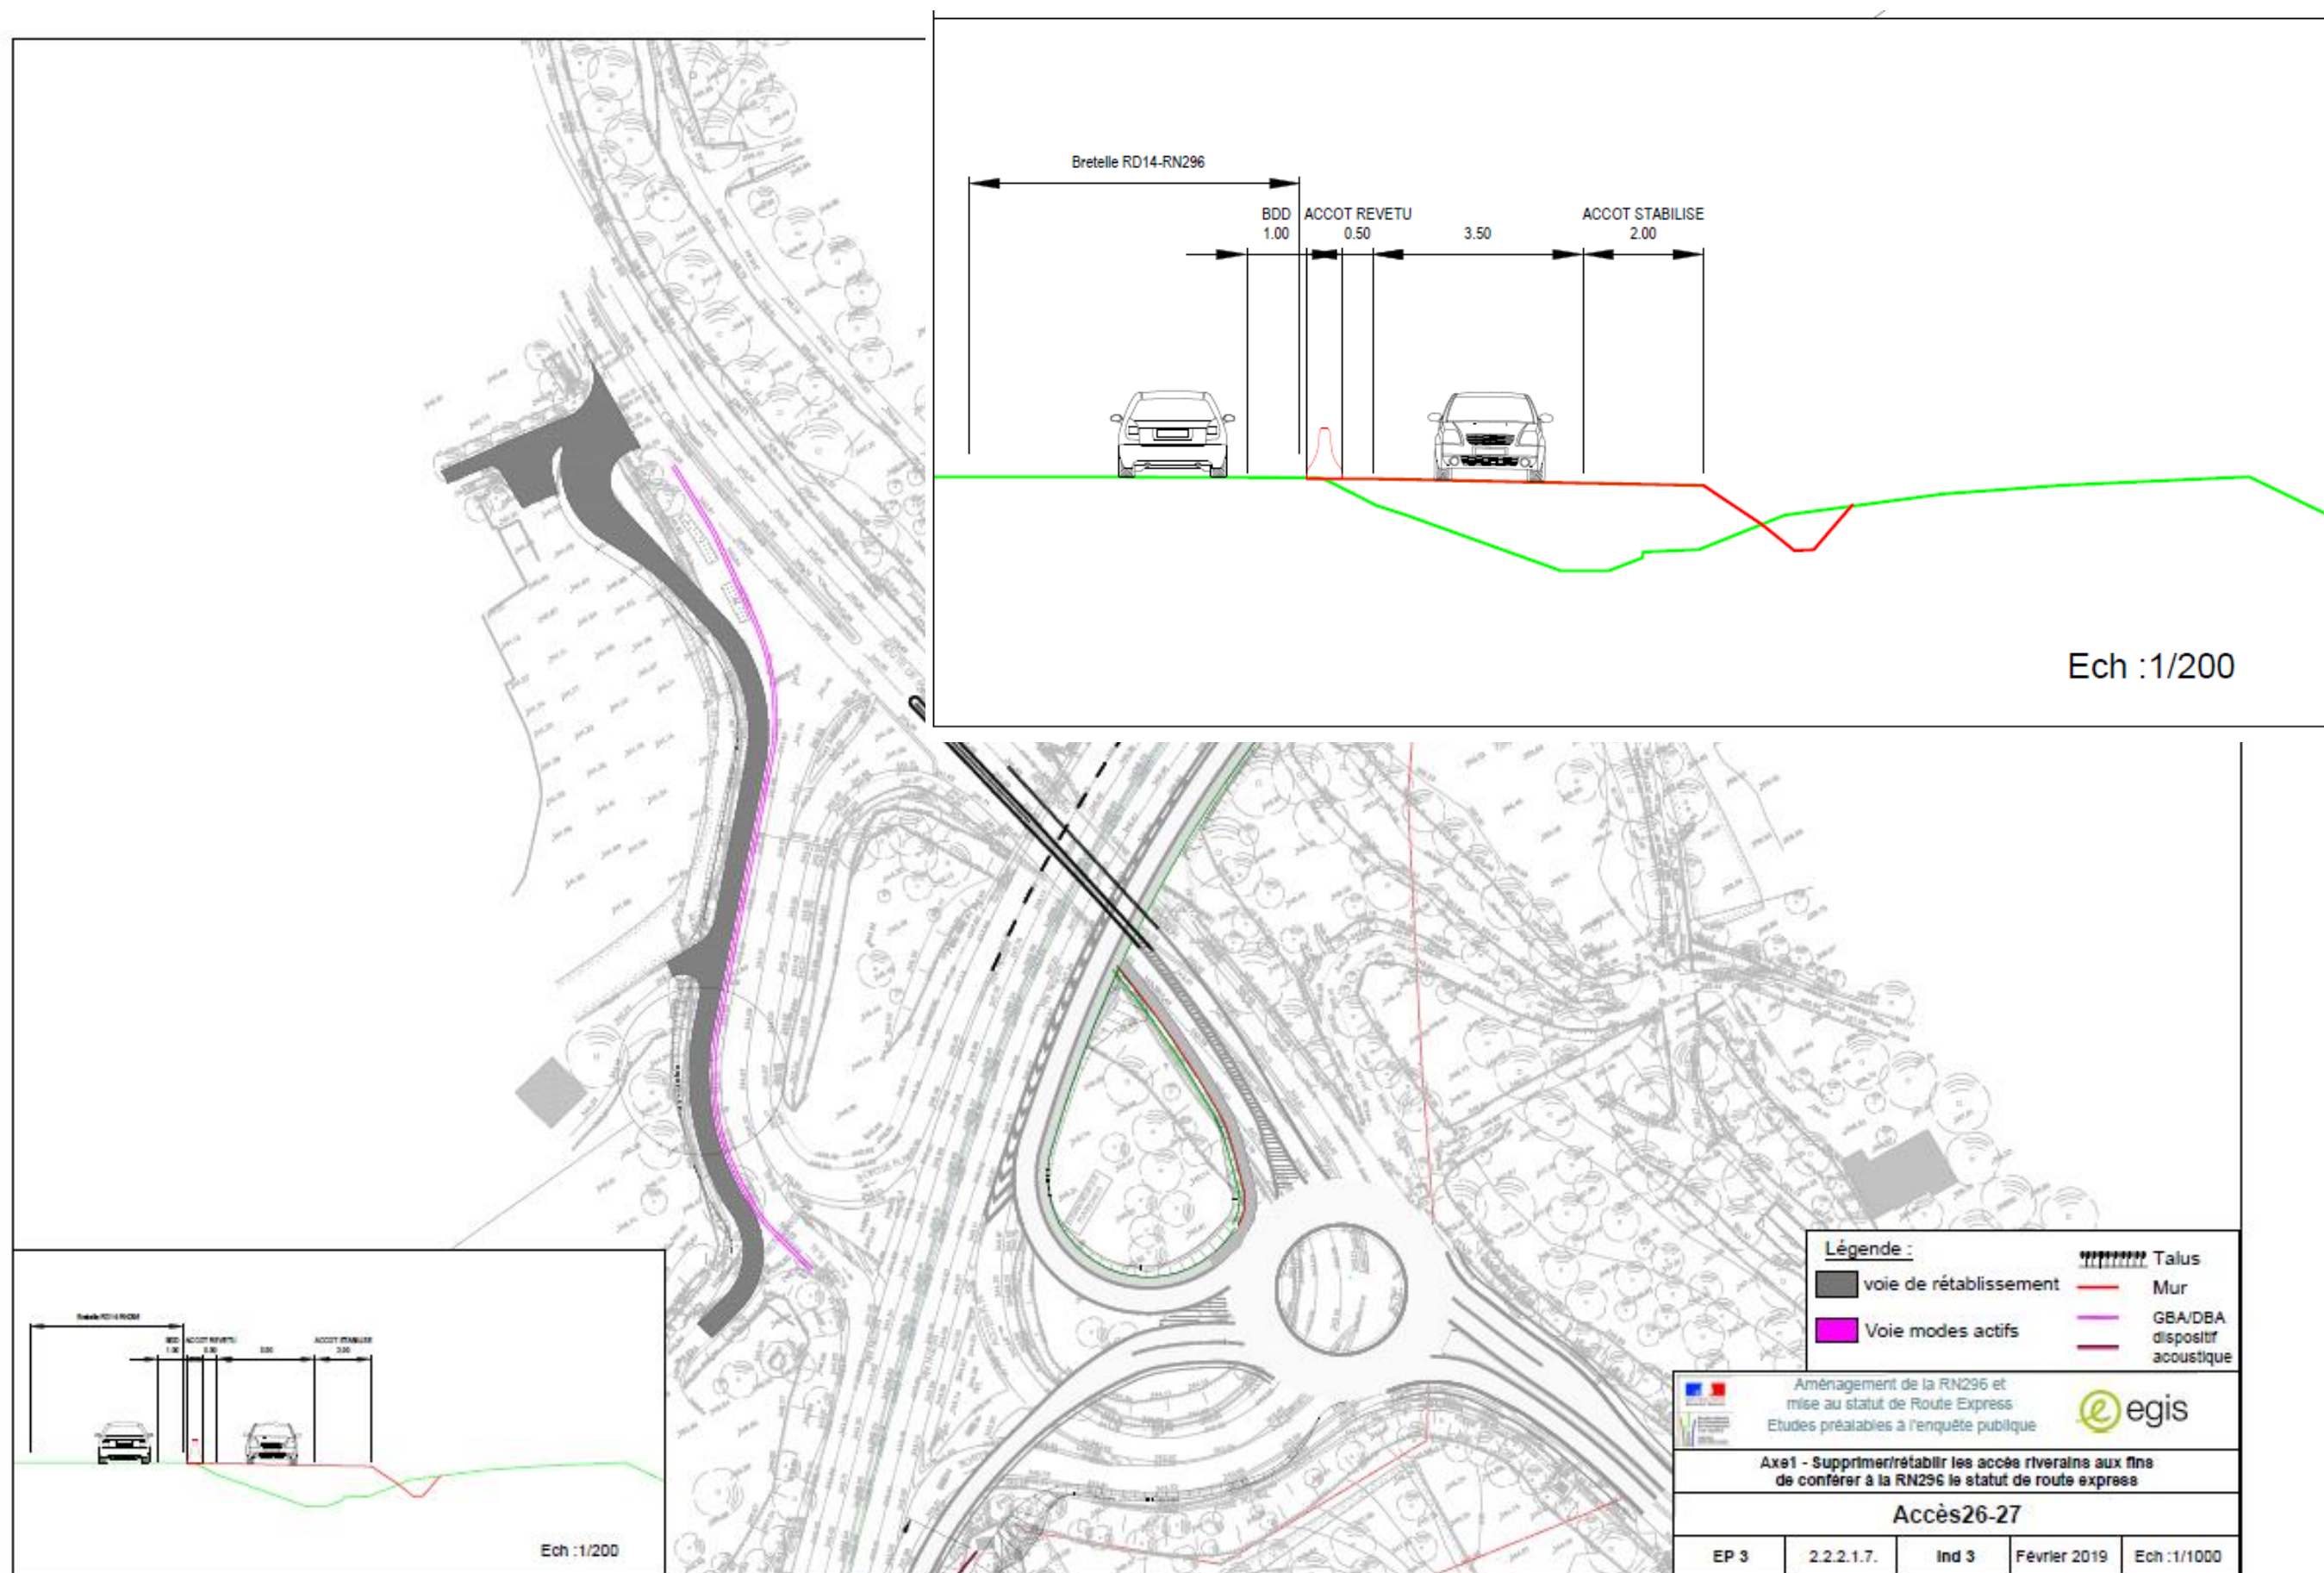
Profil en travers et vue en plan du réaménagement des accès 26 et 27
